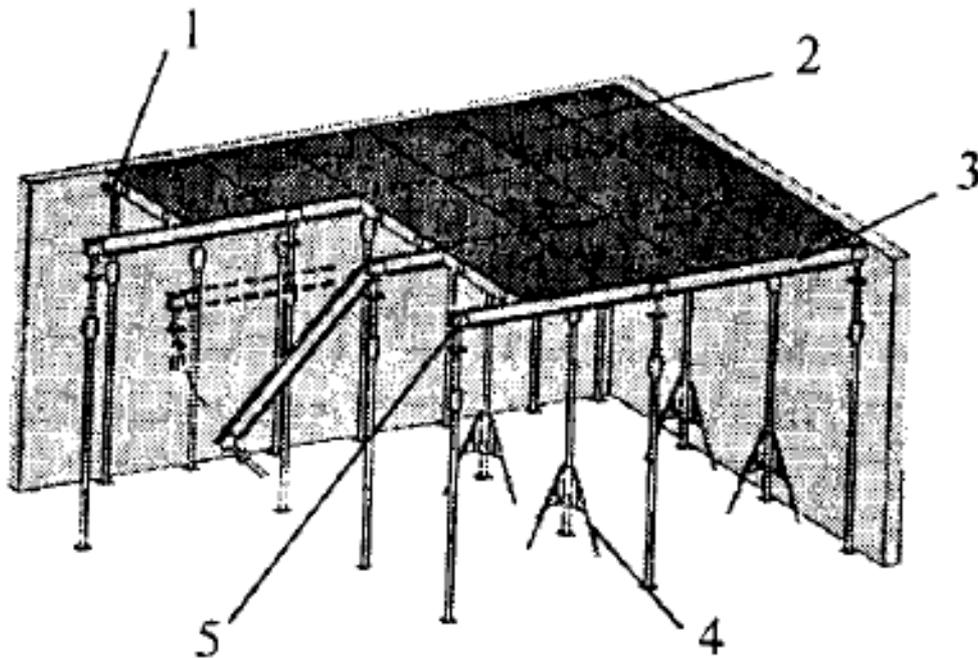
Опалубка перекрытий фирмы «Мева»:
